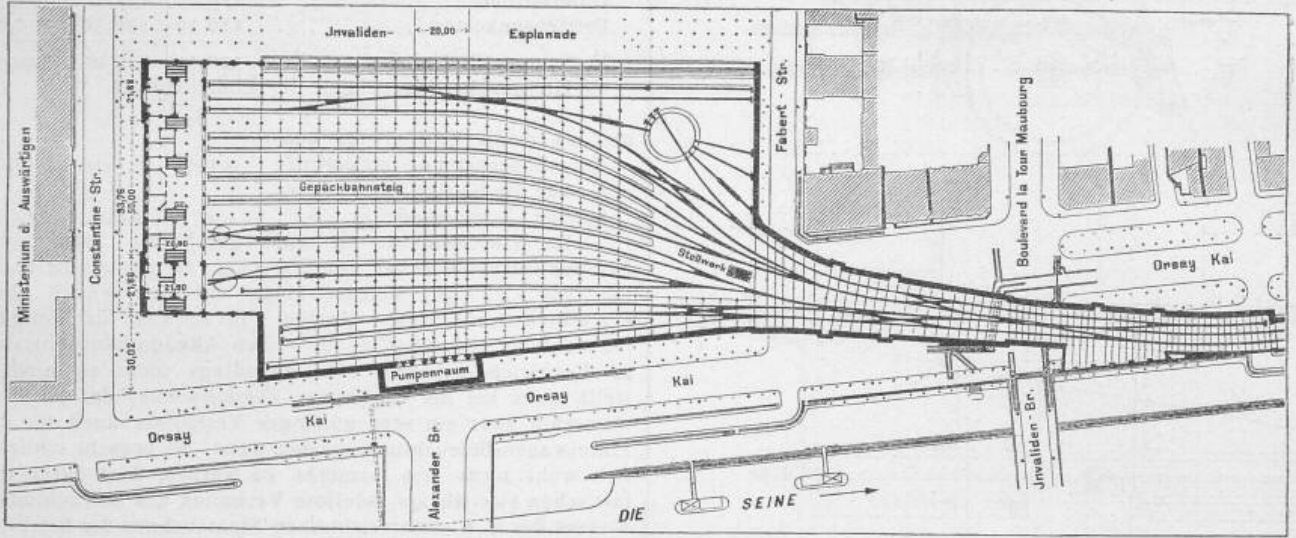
Grundriss des Bahnhofes an der Invaliden-Esplanade.
